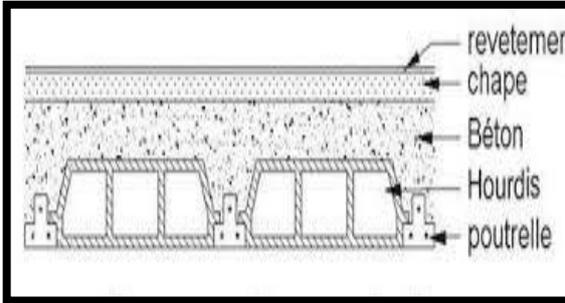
détail de ferrillage d'un plancher à corps creux :
